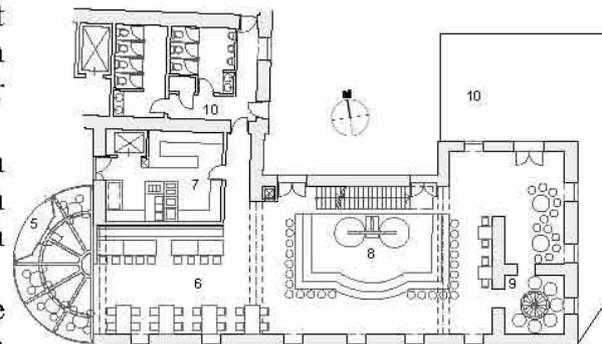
Brauerei Restaurant Erdgeschoss
